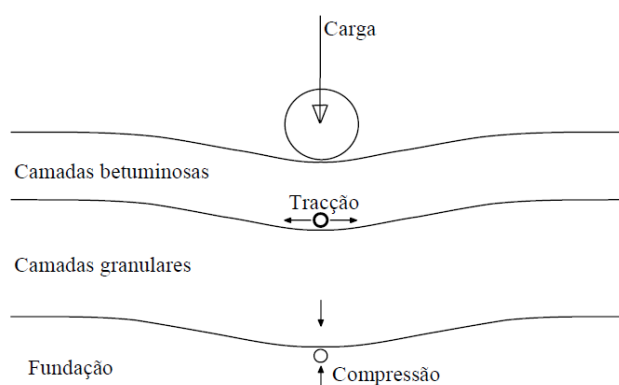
Efeito da aplicação de carga na camada betuminosa
